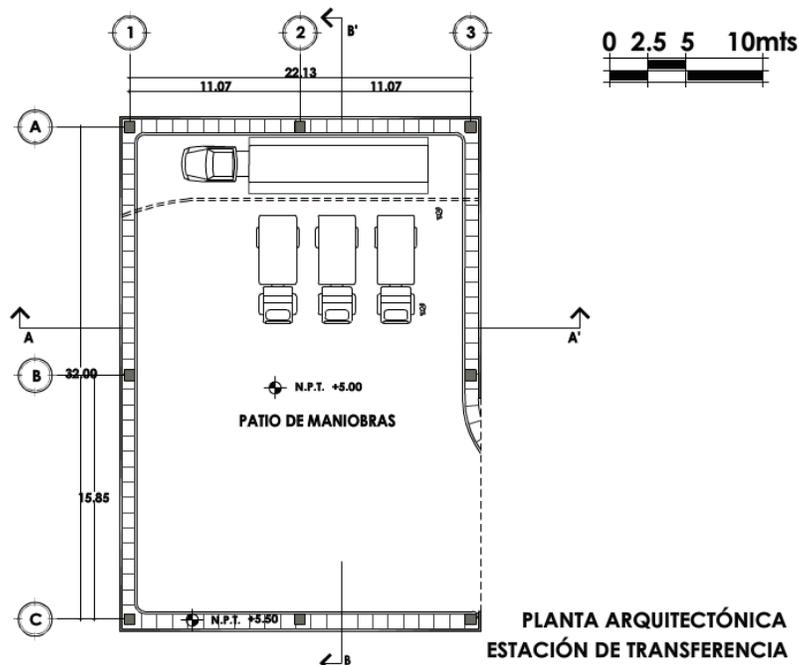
Planta arquitectónica, estación de transferencia (patio de maniobras, planta)
